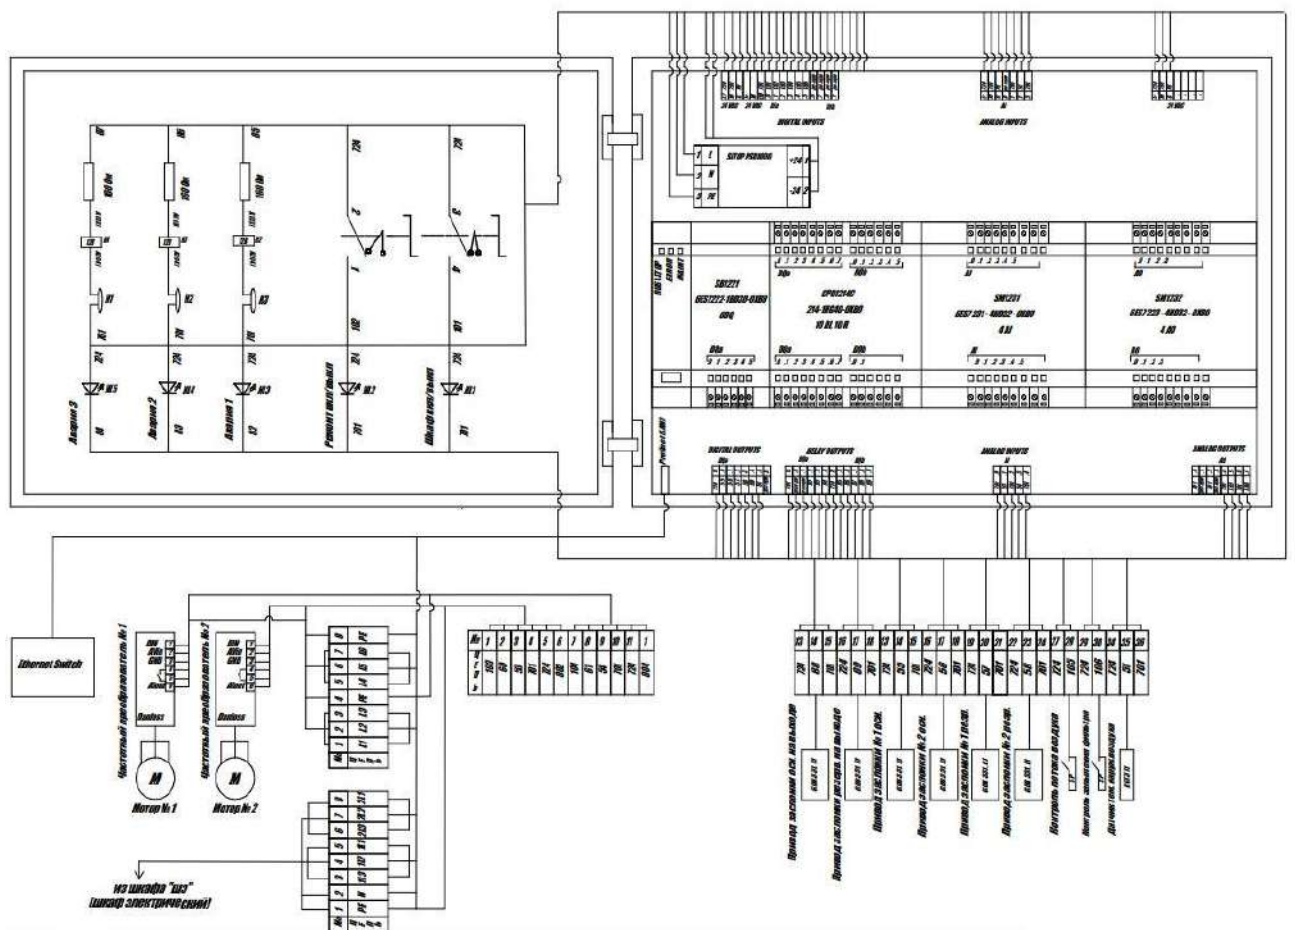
Общая принципиальная схема вытяжной вентиляции
